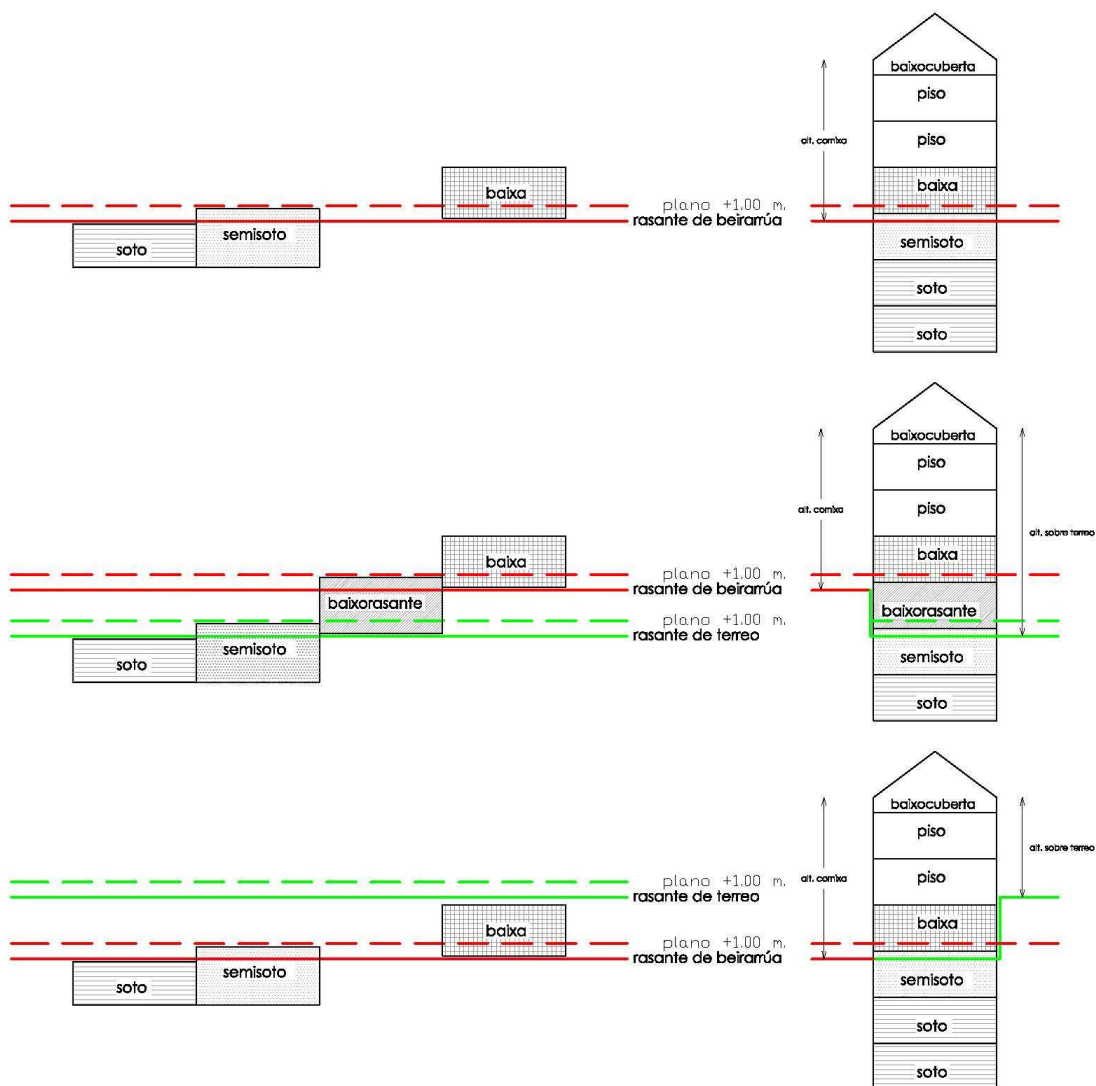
Posición de plantas soto, semisoto, baixorasante e baixa con respecto a rasante de beirarrúa e a rasante do terreo
